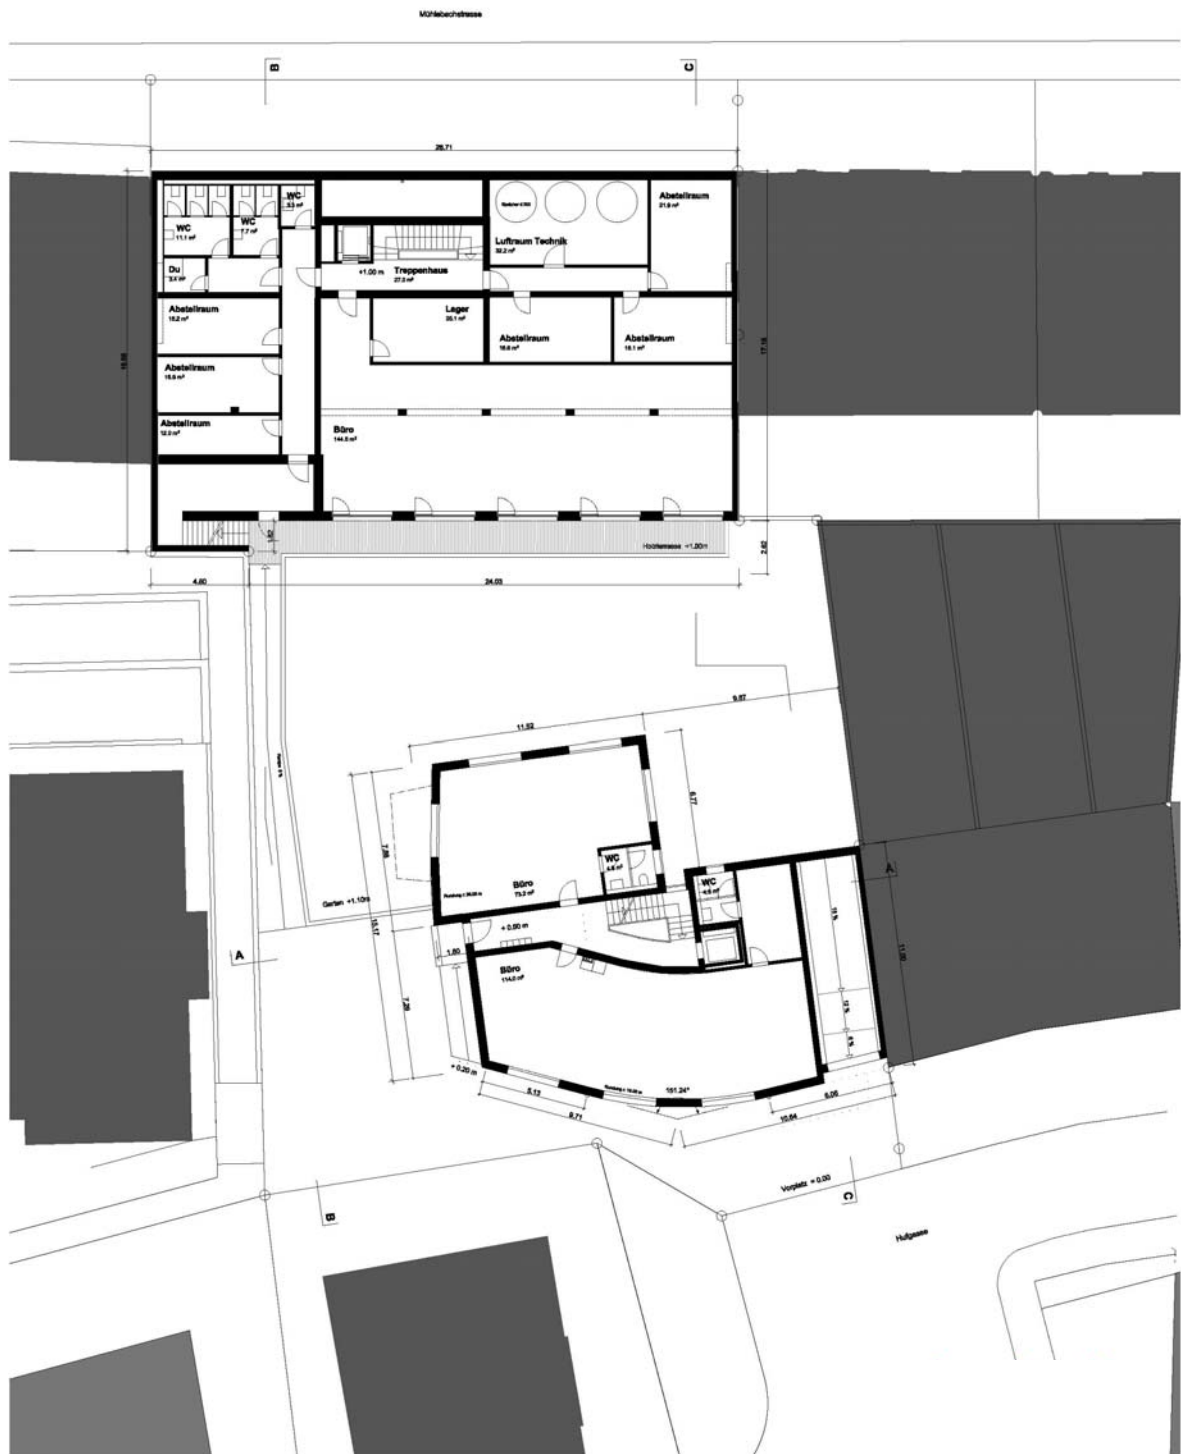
Provisorischer Grundriss 1.UG, Wohn- und Bürogebäude Mühlebachstr. 8 und Hufgasse 11, Zürich
